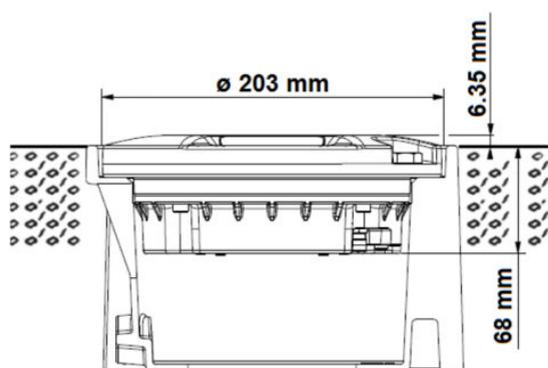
Abmessungen für 8-Zoll-Feuer
